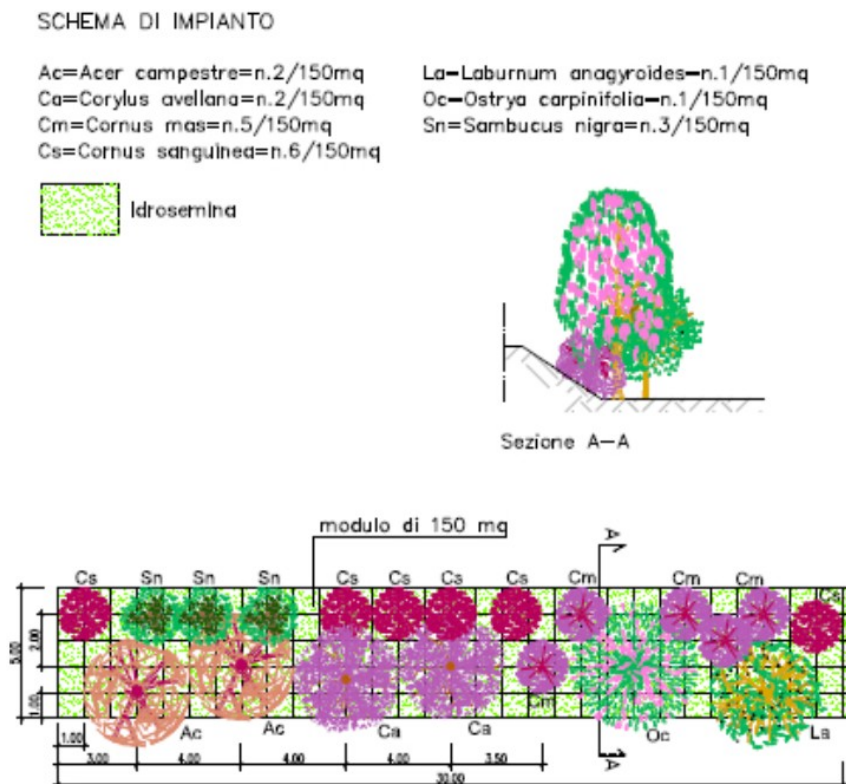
Schema sesto di impianto opere di mitigazione a verde sui rilevati stradali.
